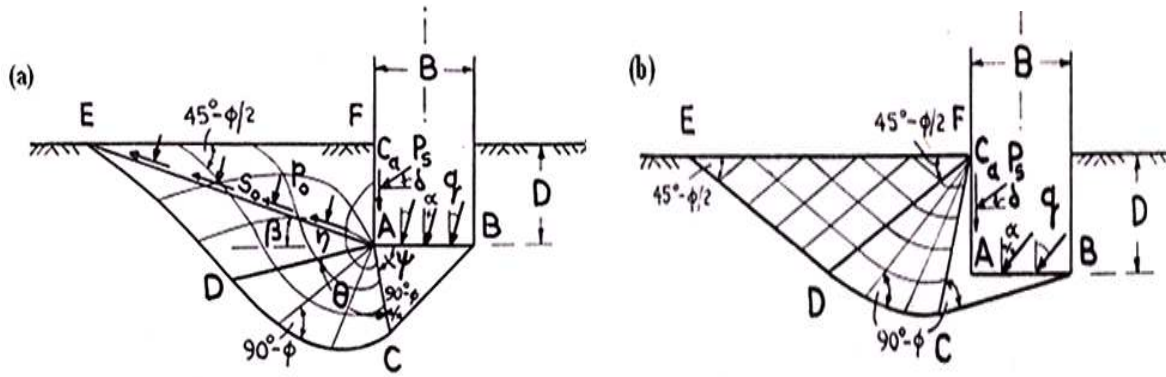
Schéma de rupture (a) faible inclinaison ; (b) grande inclinaison, d'après Meyerhof (1953).
